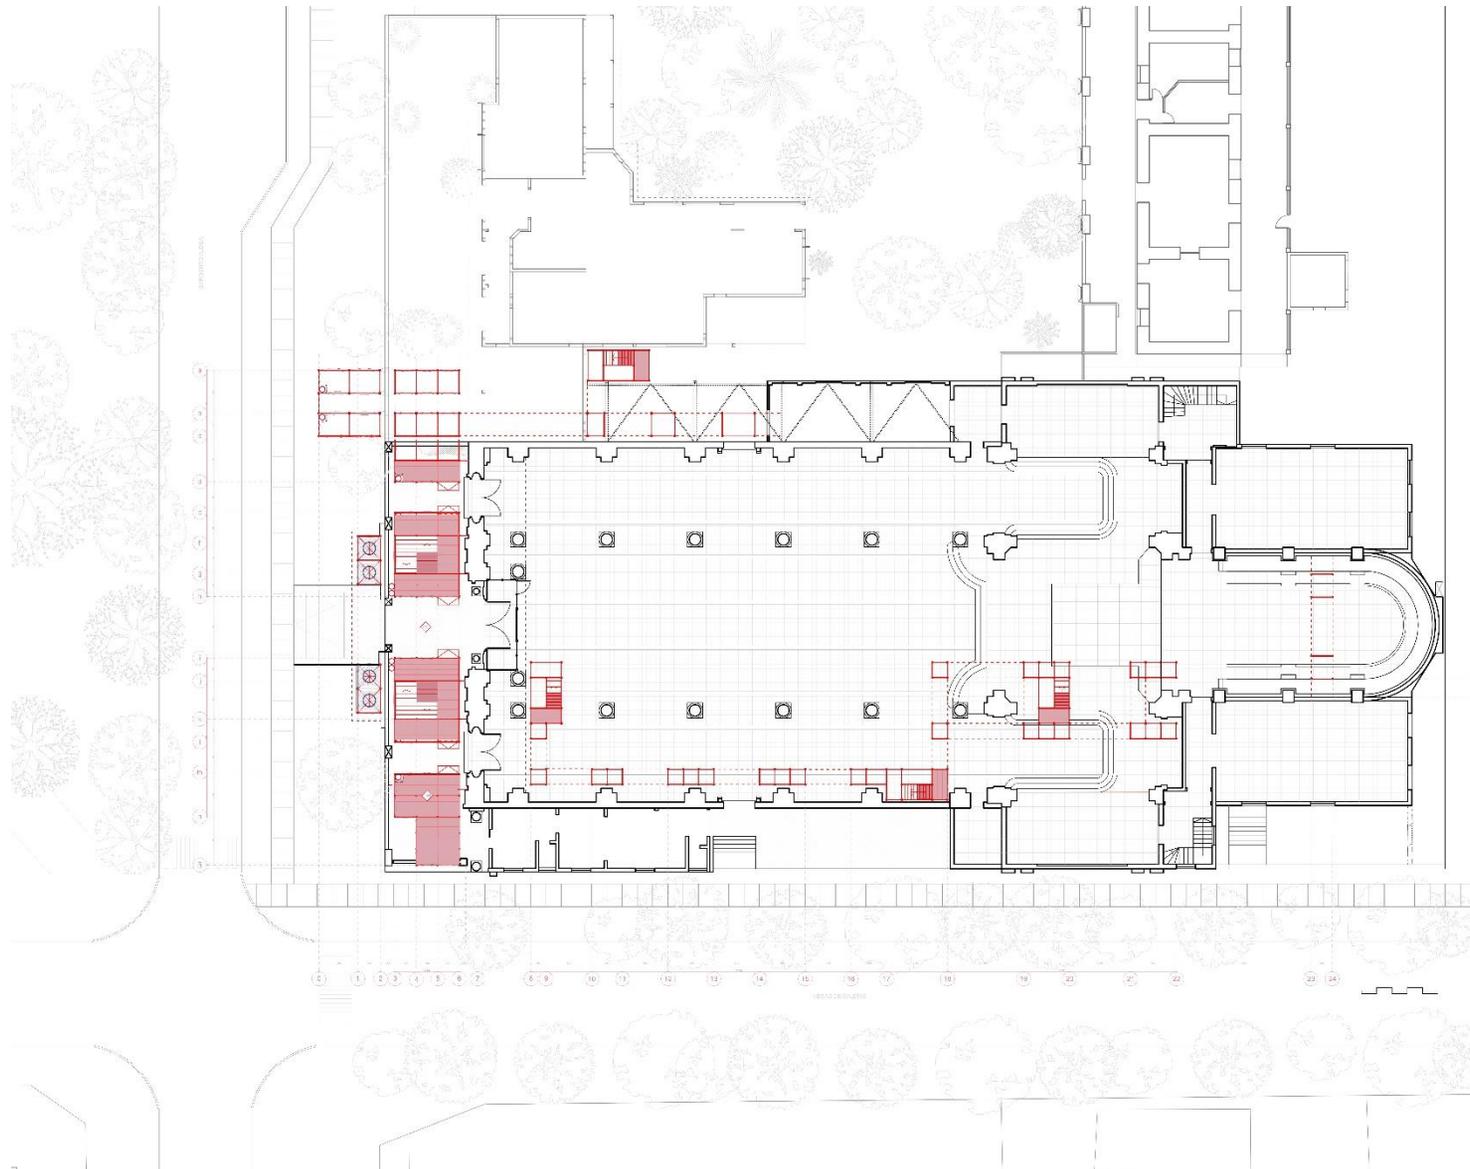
Planimetría proyecto primer nivel. Elaboración propia-
